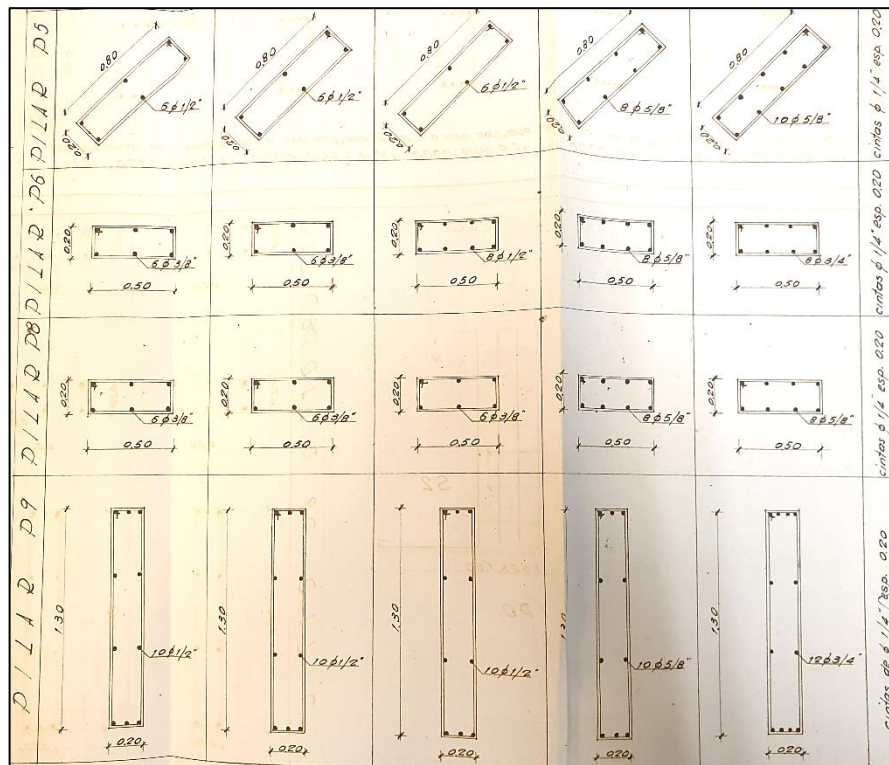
Projeto de estruturas do edifício tipo (2/2)
